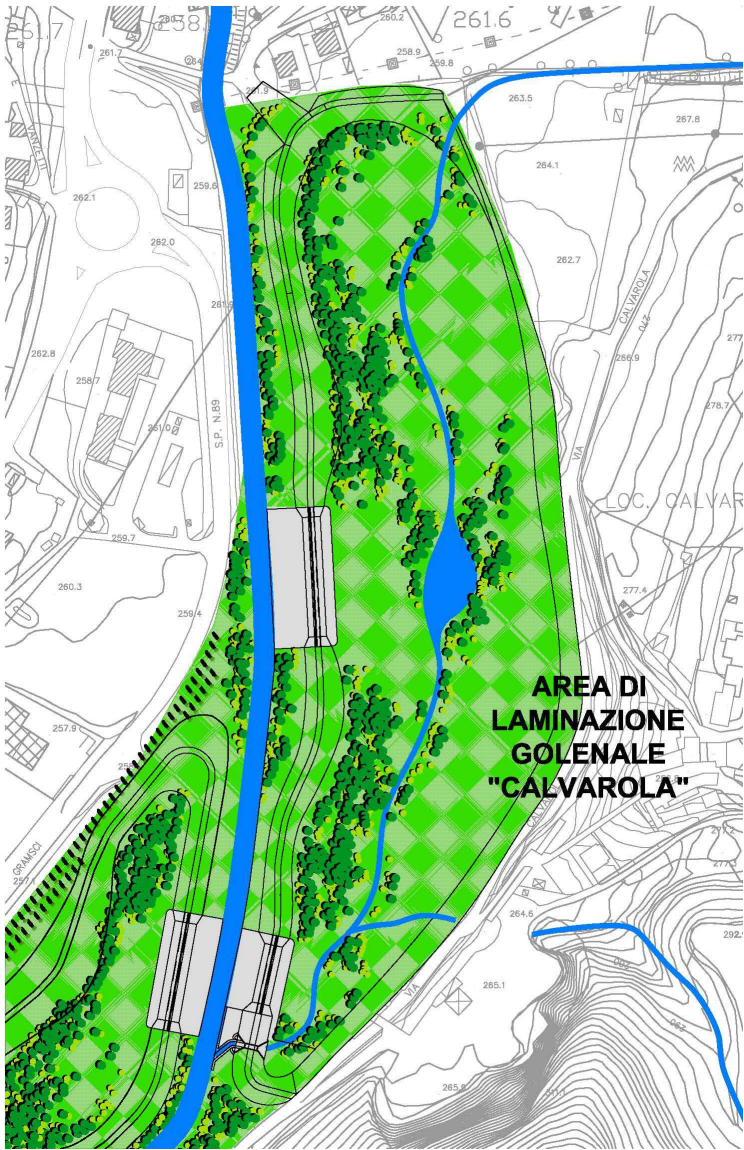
Planimetria dell’area di laminazione golenale “Calvarola”
